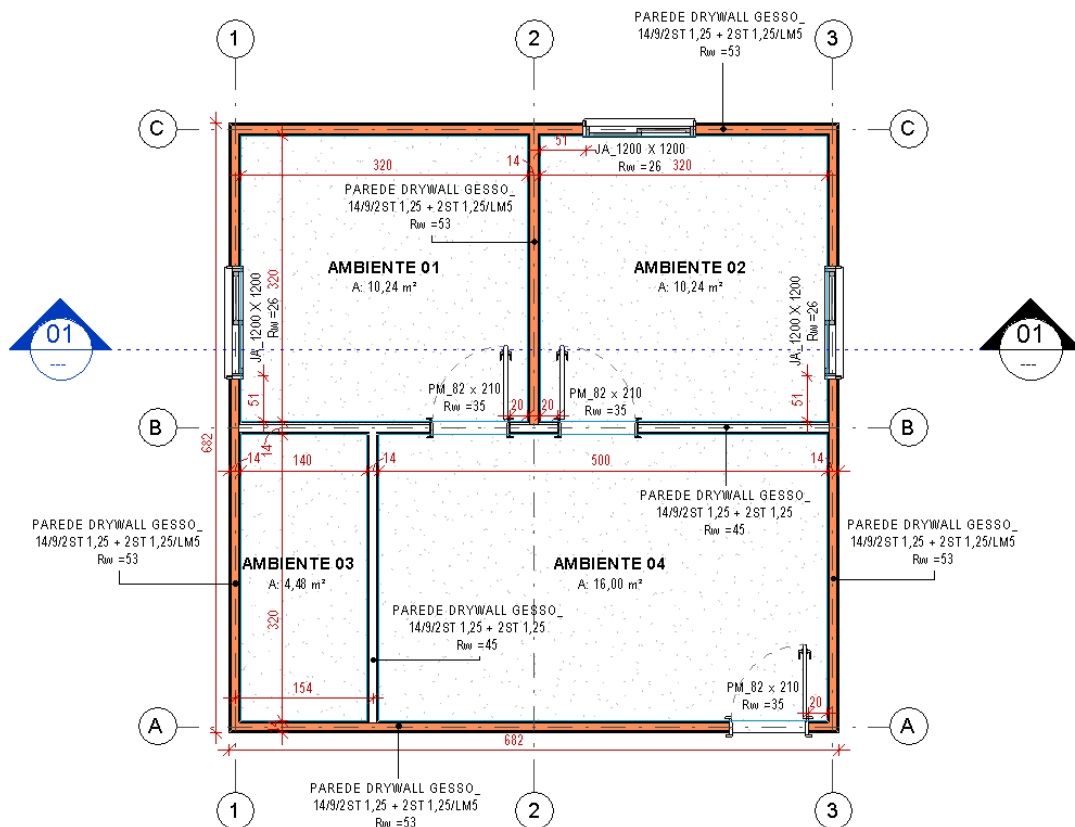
Planta baixa do Protótipo 01 com a identificação dos elementos construtivos. Fonte: Autor.
